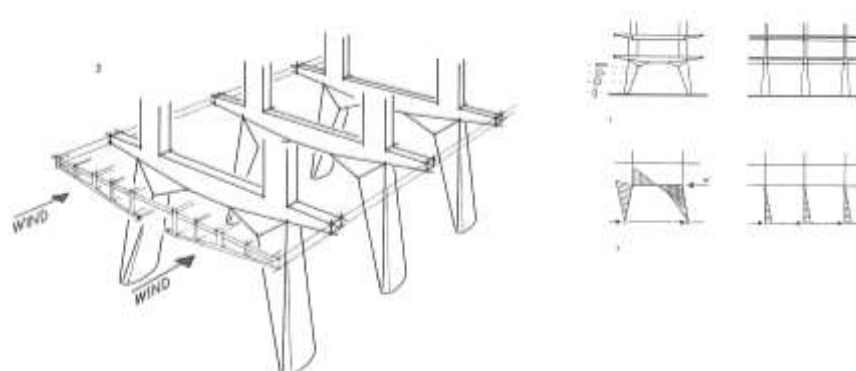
, 6.32, 6.33. Esquema estructural del Hospital Sul América, 1952. Detalle de nervaduras de acero de pilar en “V”; sección elevación longitudinal y esquema de cargas y estructura. En: Court Siegel, *Structure and Form in Modern Architecture*, New York, 1975.org
